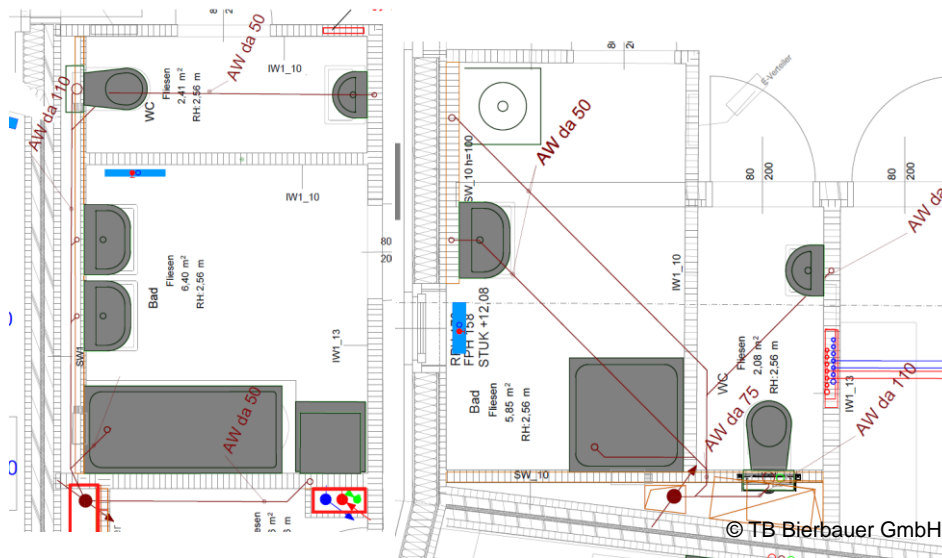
Abwasserleitungen in der Vorsatzschale in Bauabschnitt 5 (links) und Leitungsführung im Fußbodenaufbau in Bauabschnitt 4 (rechts)
